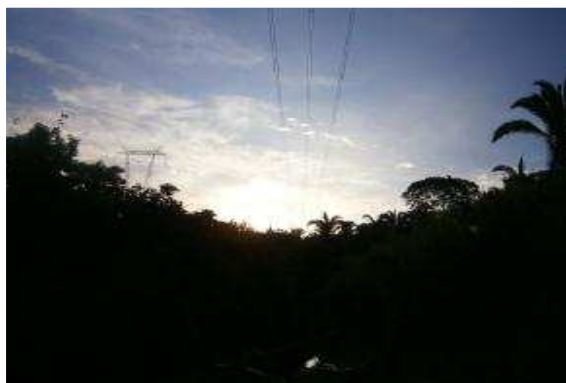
Vista da praça de torre 100 do trecho 1, sentido ré. Coordenadas UTM Zona 21 663758 E8247801N, 14/11/2012.
